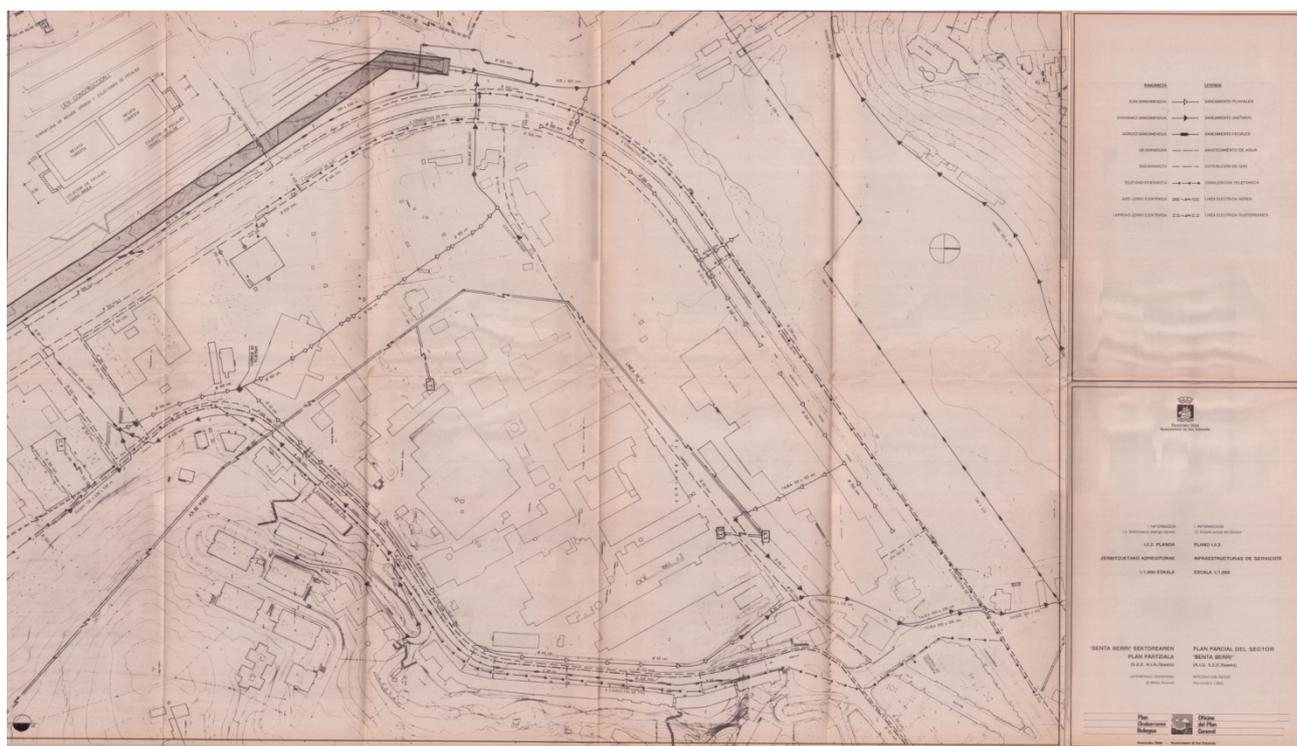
Plano I.2.2. de Infraestructuras y Servicios - P.P.O.P.G.
